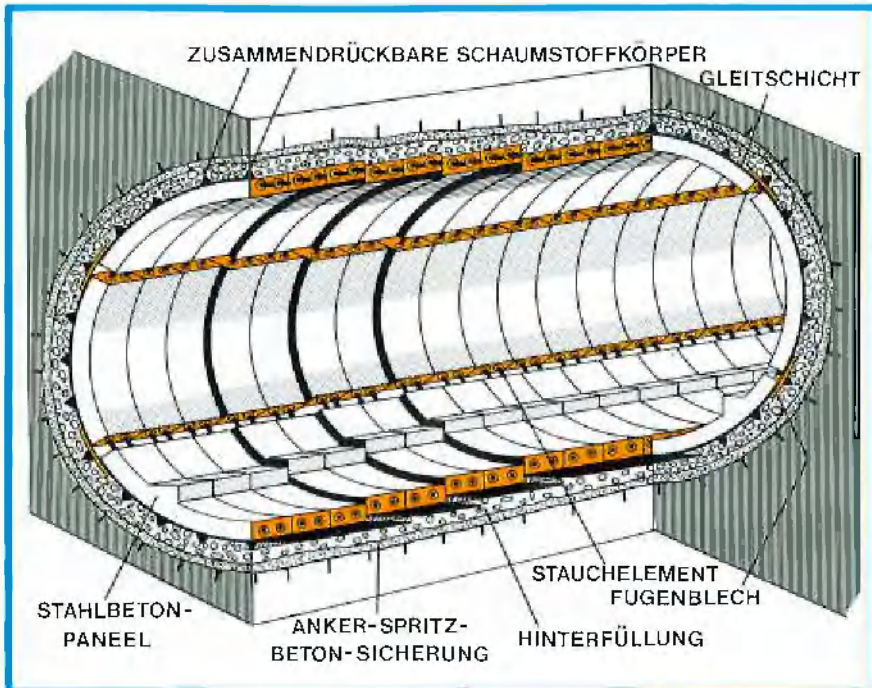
Schema des fertig eingebauten nachgiebigen Betonpaneelbaus
